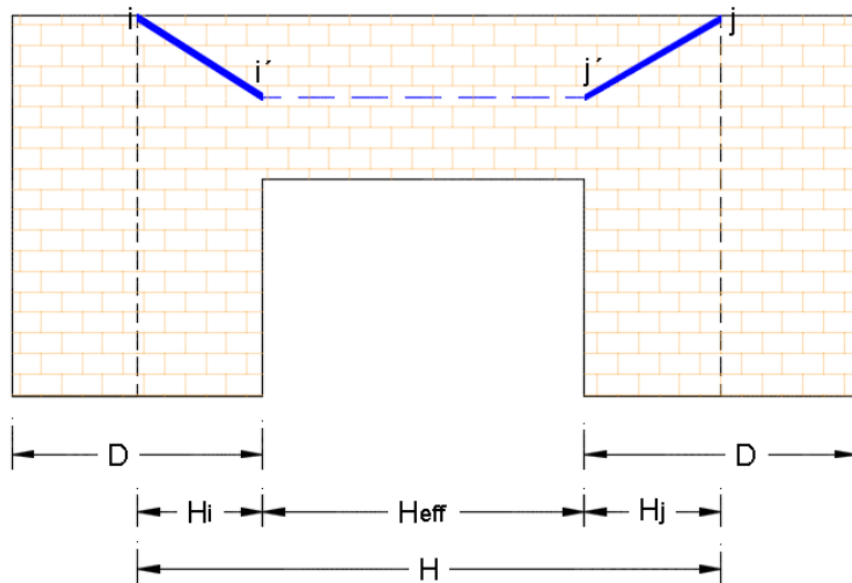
Elemento estructural horizontal (Viga dintel)
